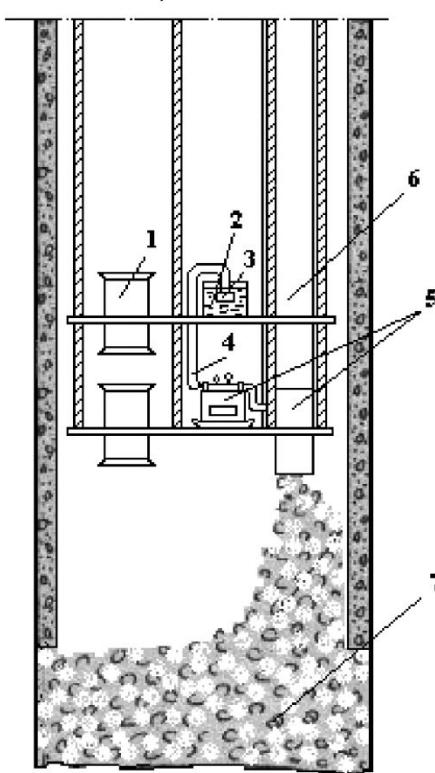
Технологическая схема подачи пены в забой ствола : с рабочего полка; 1-раструб; 2-ёмкость с водой; 3-пневмонасос Н-1М; 4-водоподающий шланг; 5-установка пеногенераторная; 6-вентиляционный трубопровод; 7-низкократная пена
